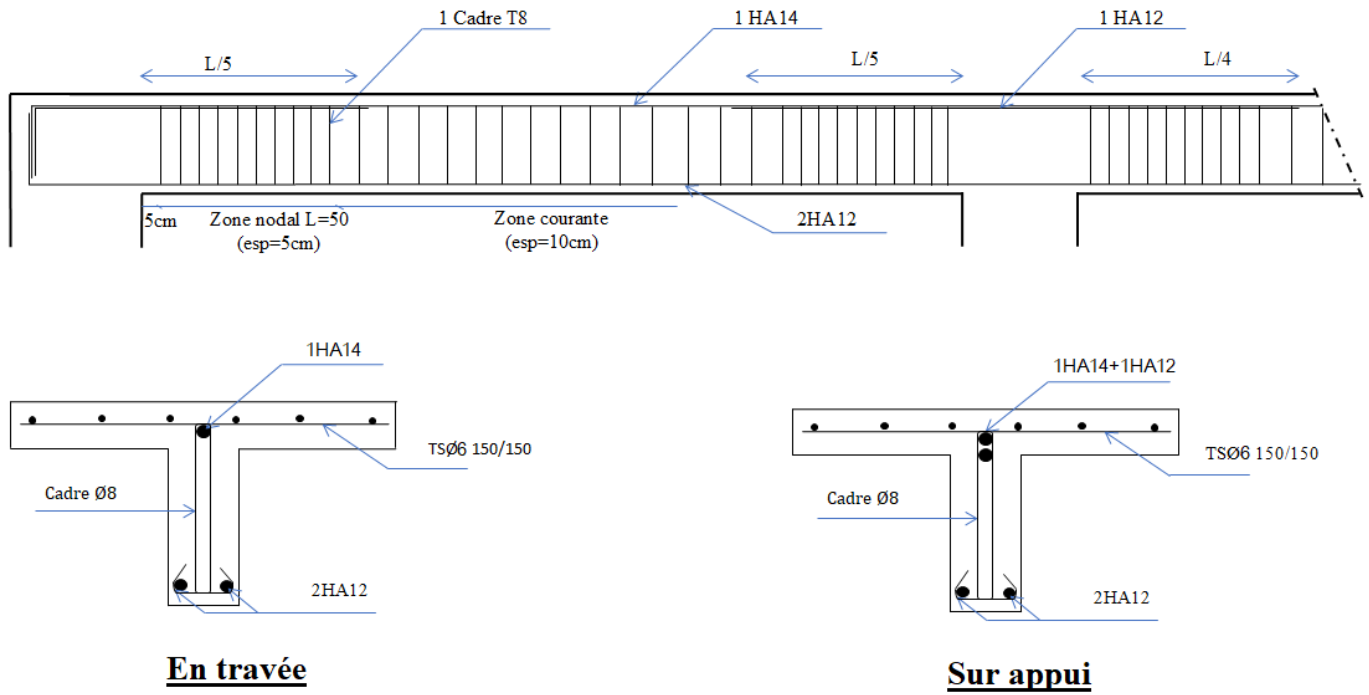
Schéma de ferrailage des poutrelles
